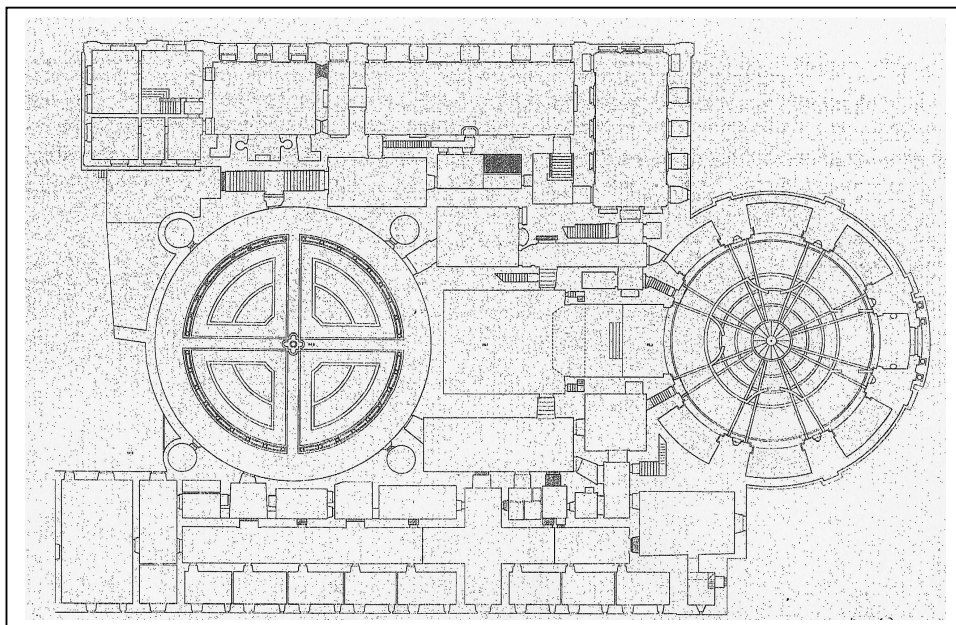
Planta do Mosteiro da Serra do Pilar
